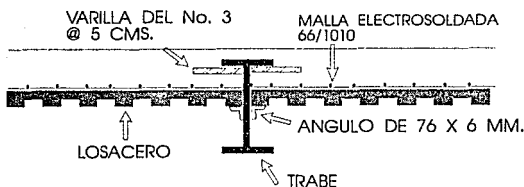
LOSA DE ENTREPISO A BASE DE LOSACERO
